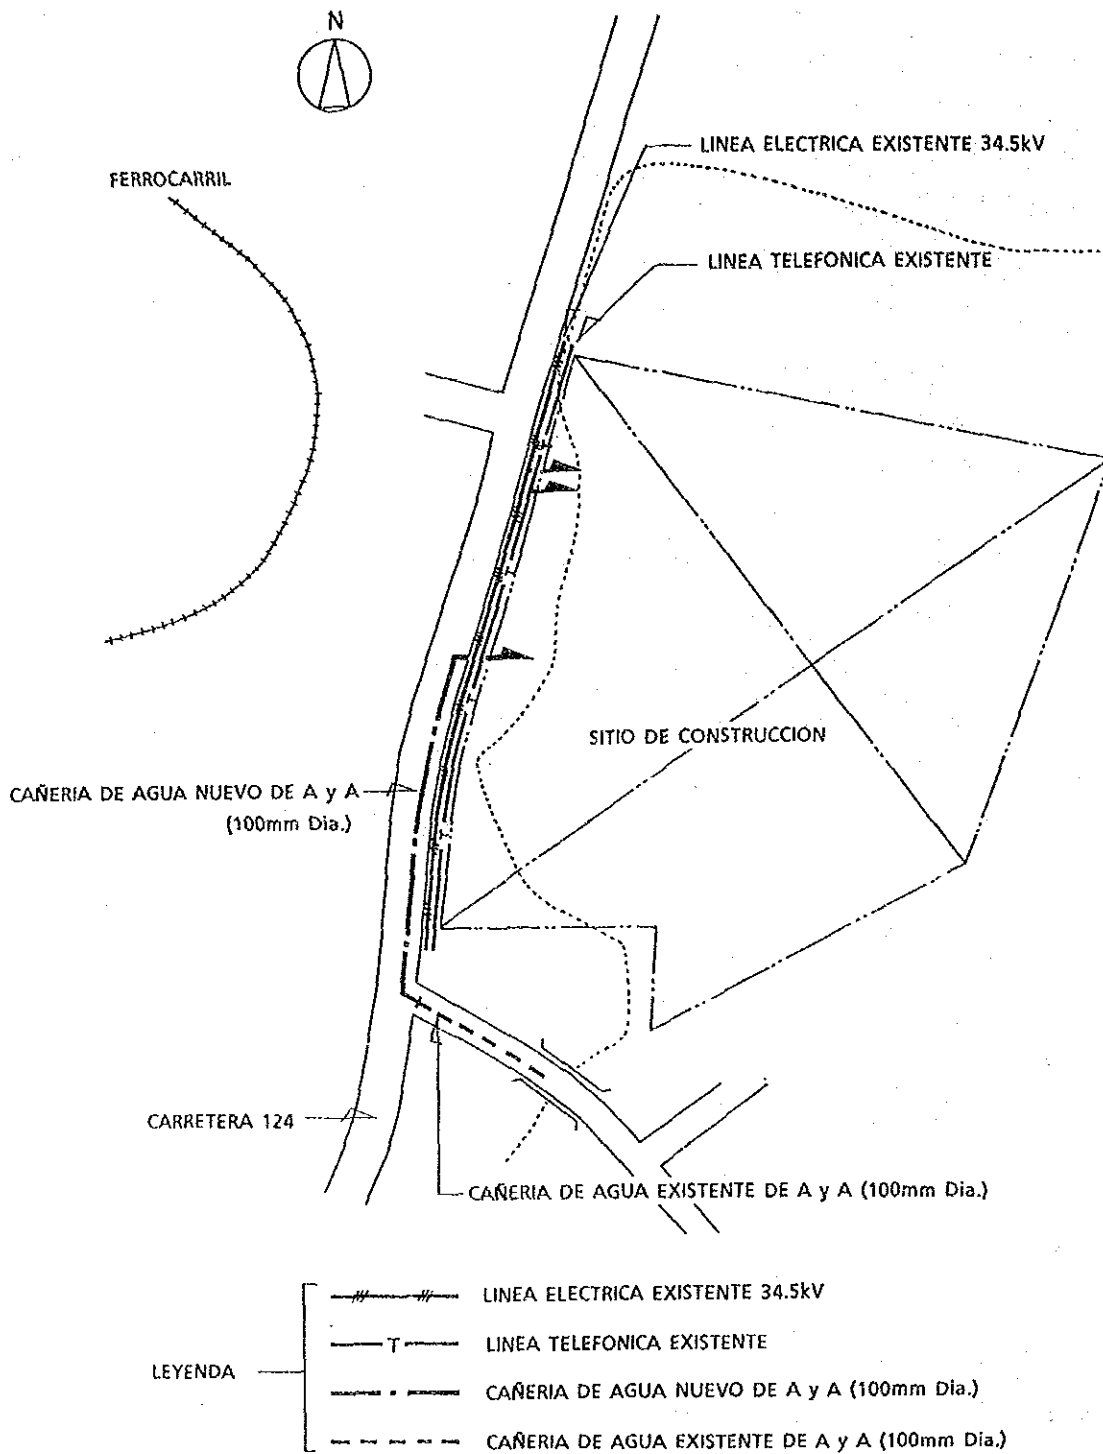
Infraestructura Alrededor del Terreno de Construcción Prevista
